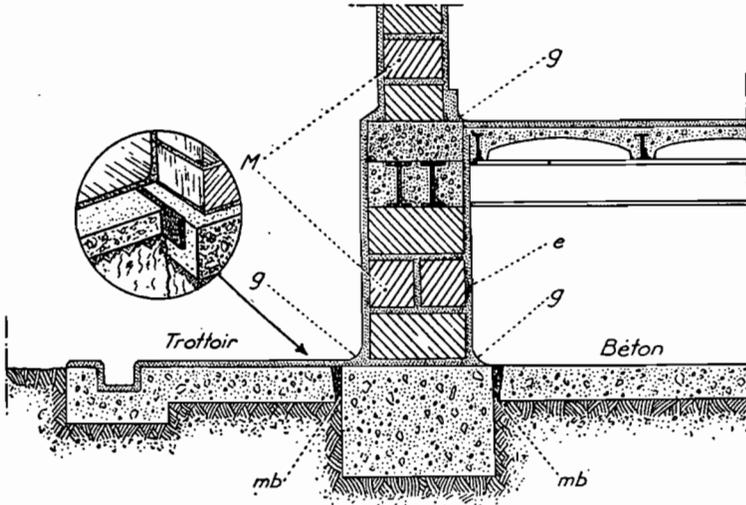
Bâtiment en maçonnerie avec plancher en ciment armé.
